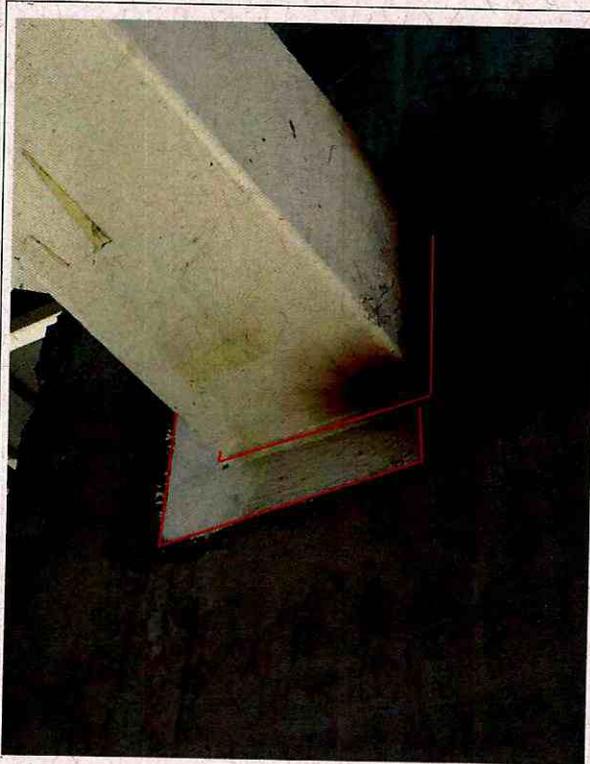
Anclaje ejecutado en el pilar de hormigón armado, en el eje 39, fuera del eje vertical.
